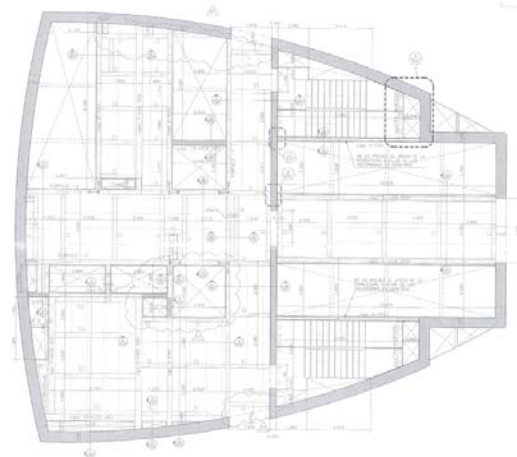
Planta y aspecto del núcleo interior del edificio
